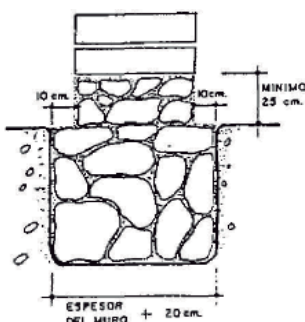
Cimentación y sobrecimiento de piedras para proteger el muro de tierra del ascenso de la humedad.
